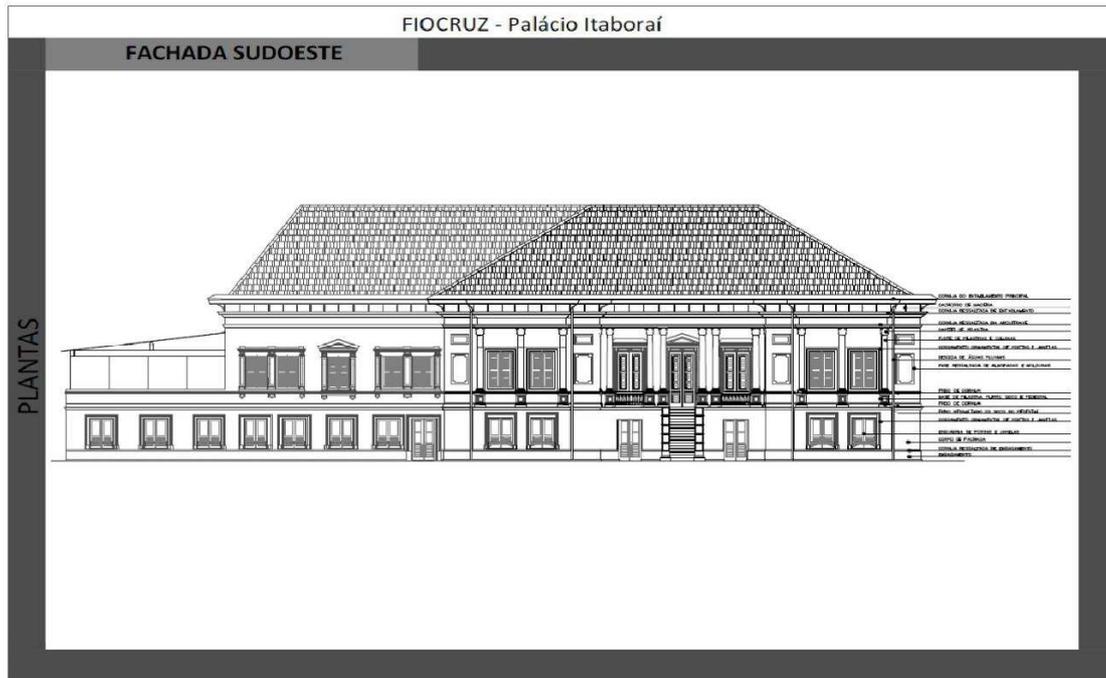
Anexo III Plantas– Fachada Sudoeste ou Principal. Fonte Plano de Conservação do Palácio Itaboraí, 2013.
